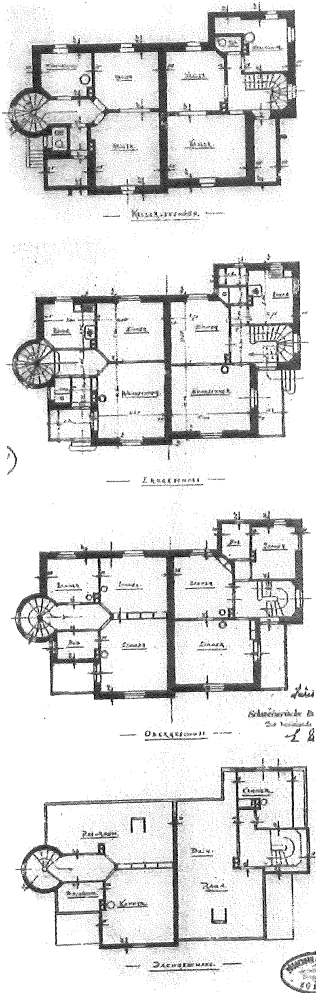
Haustyp 4, Horwstrasse 5 - Grünging 4 Luzern, Grundrisse Untergeschoss bis Dachgeschoss Baueingabeplan 1:280
